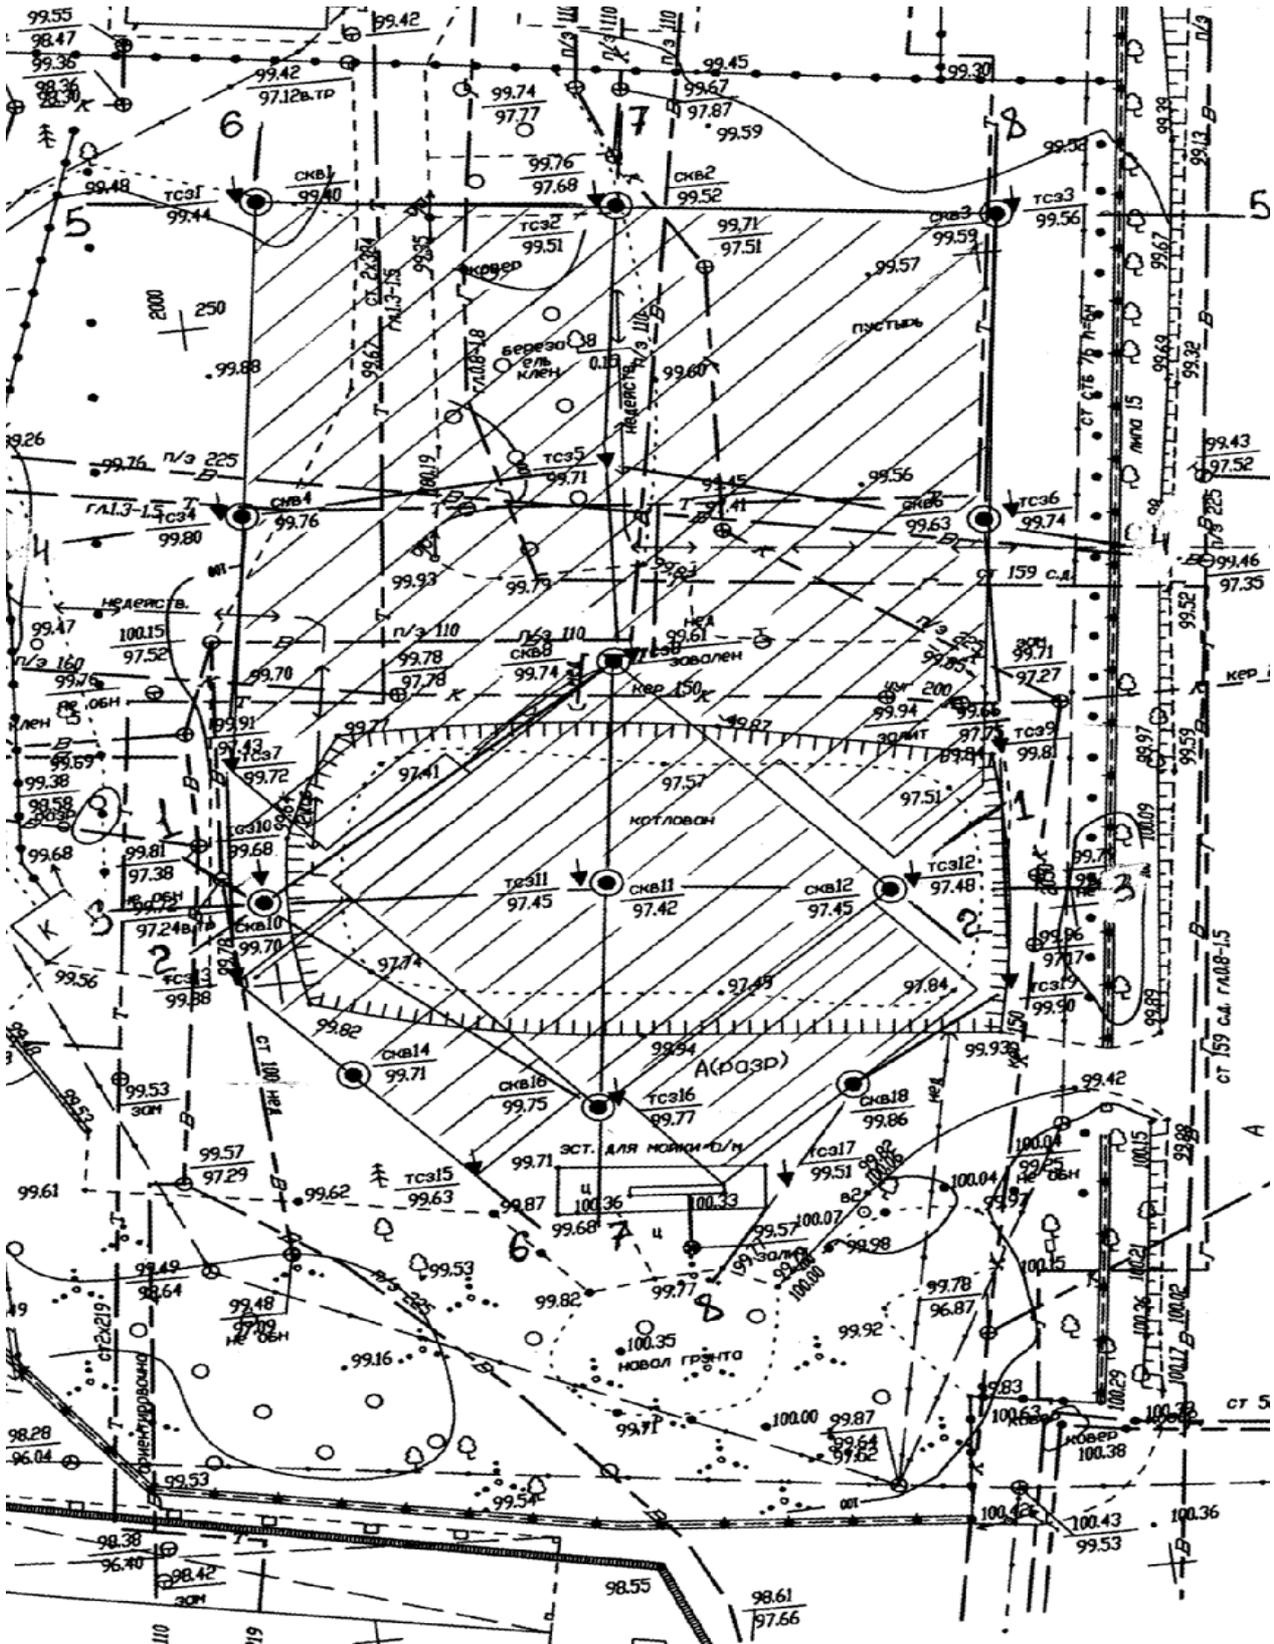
Схема плана строительной площадки с нанесенными инженерно-геологическими выработками и разрезами 1-1...8-8 в г. Казани
